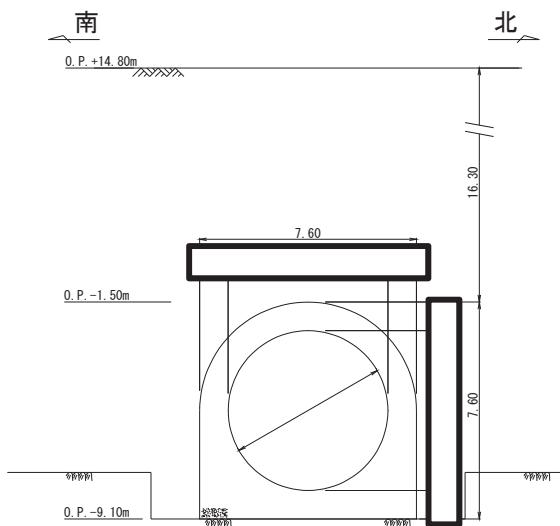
排気筒連絡ダクト断面図（土砂部, A-A）
